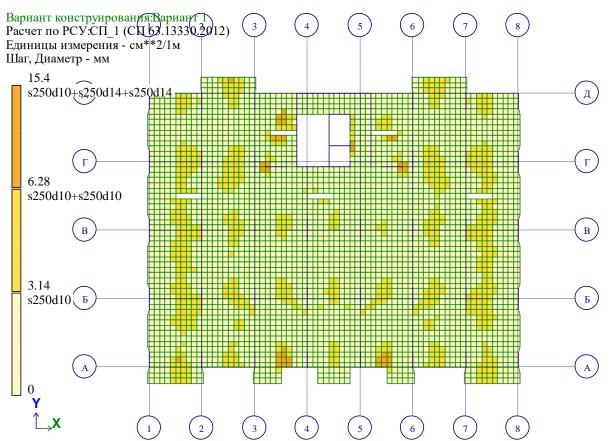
Расчетное армирование плиты над подвалом по оси У у верхней грани.
